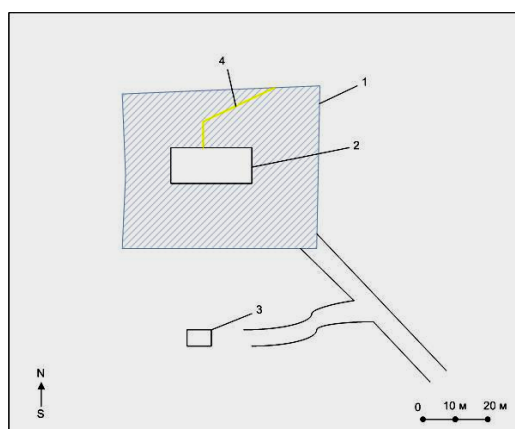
Ситуационный план объекта (схематическое изображение): 1 – граница территории котельной, обозначенная забором без ворот; 2 – здание котельной; 3 – гаражное строение; 4 – наружный газопровод ВД)
